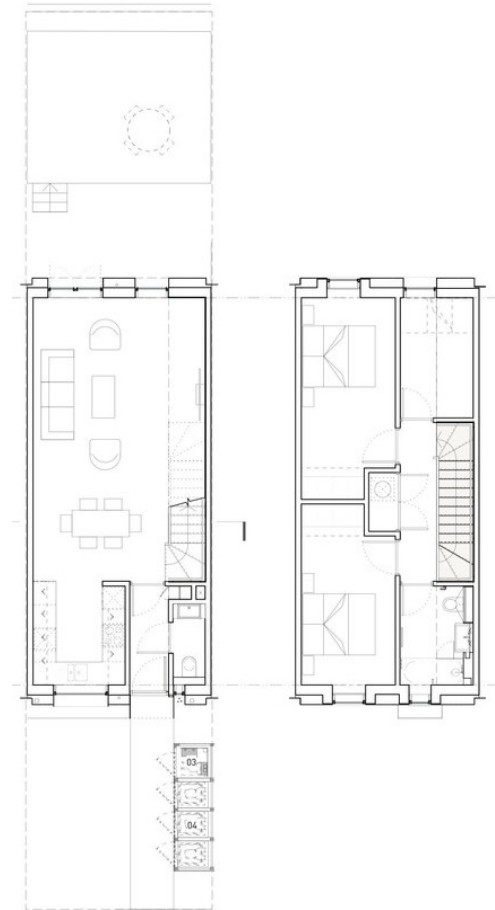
FAB house, TDO Architecture, 2018. Asuntojen etupihat ovat suuret ja rajattu toisistaan.
